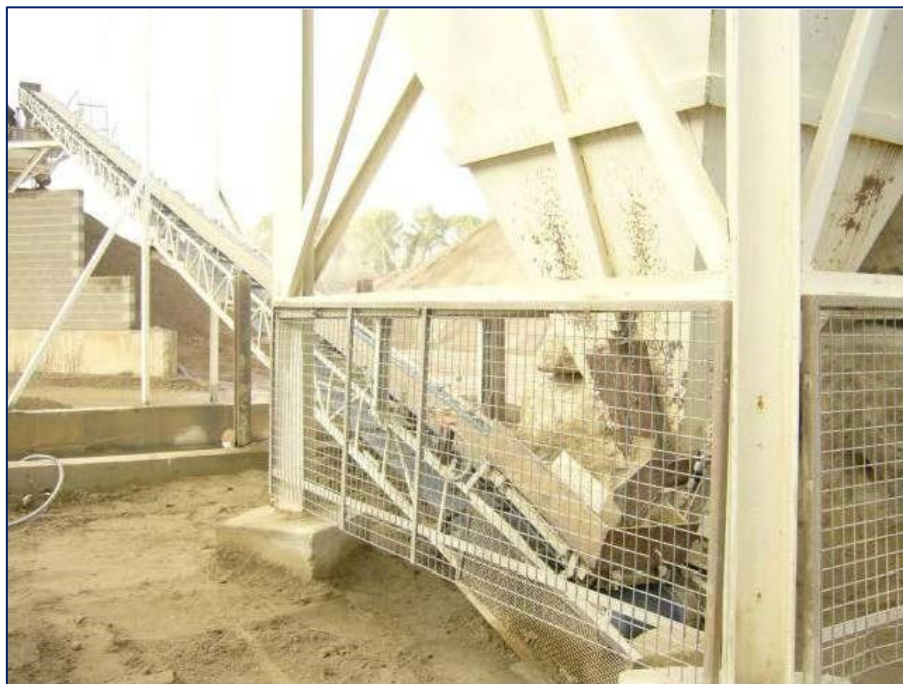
Vista Resultado Tras Implantación De Protección Compacta De Cierre
